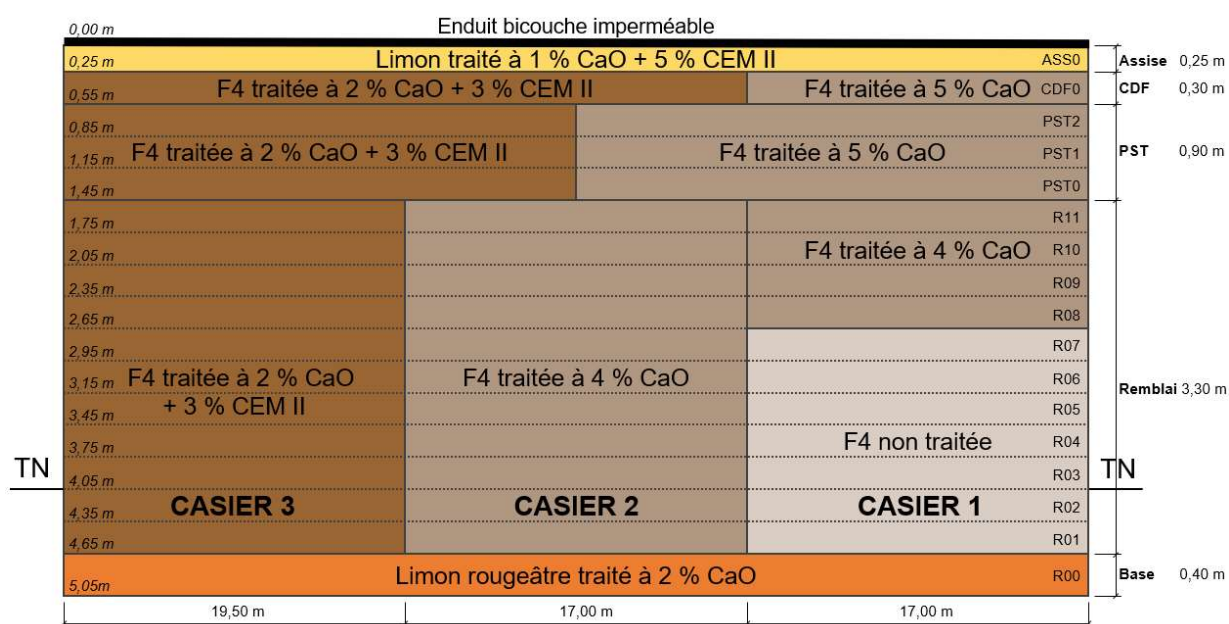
Coupe longitudinale du remblai de Héricourt (Froumentin et Boussafir, 2013).
